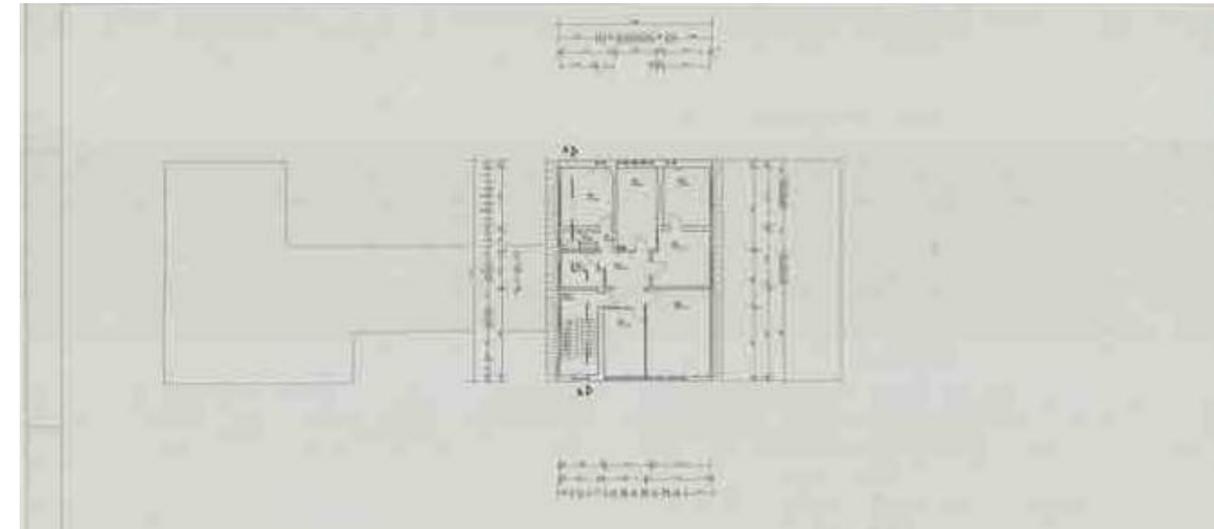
Güterabfertigung: Plan mit Grundriss des Dachgeschosses, 1998
